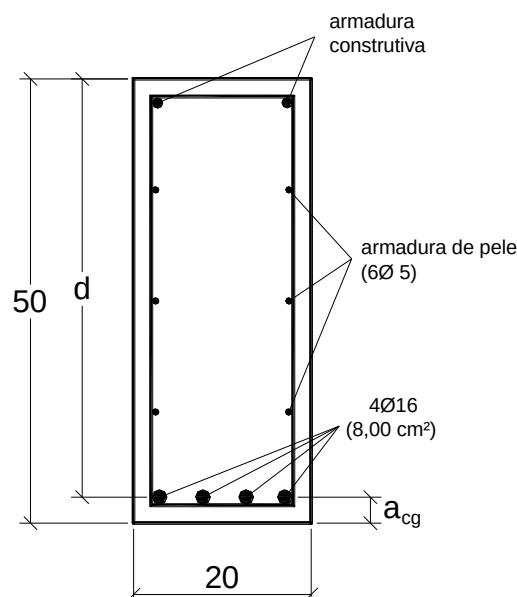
Detalhamento da armadura longitudinal A_s na seção transversal.
